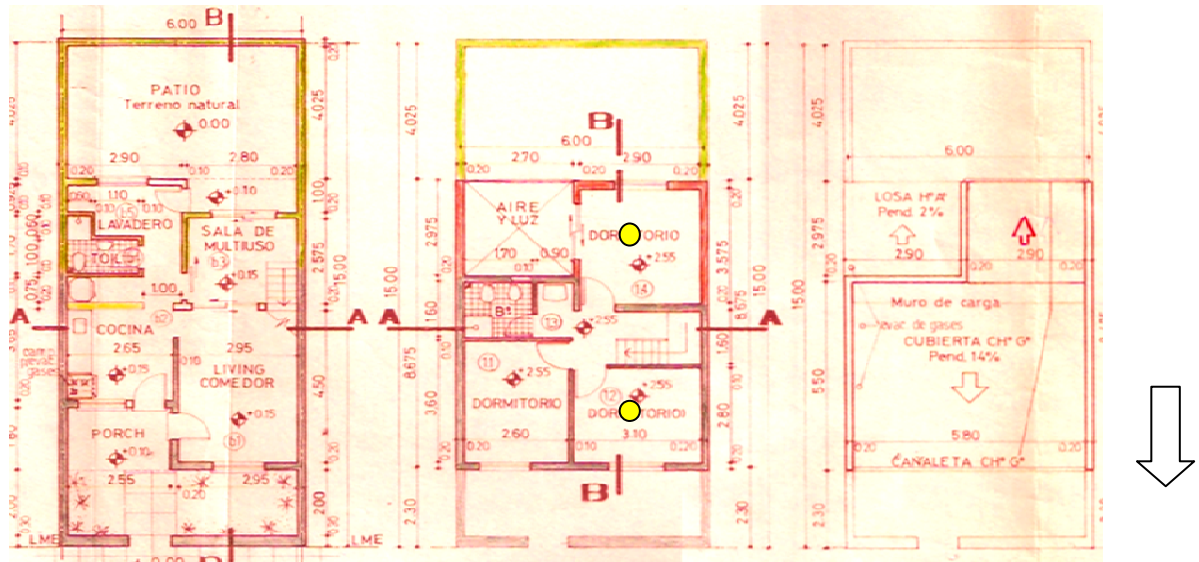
Planos de plantas baja, alta (con ubicación de sensores) y techo de la vivienda analizada
